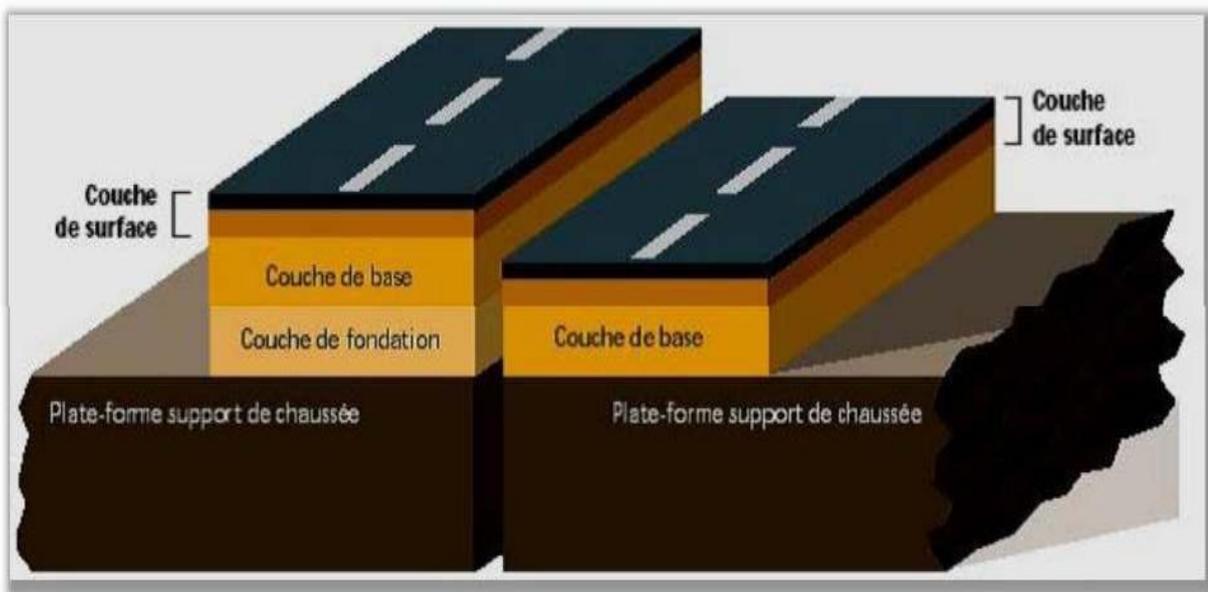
STRUCTURE D'UNE CHAUSSEE SEMI-RIGIDE
